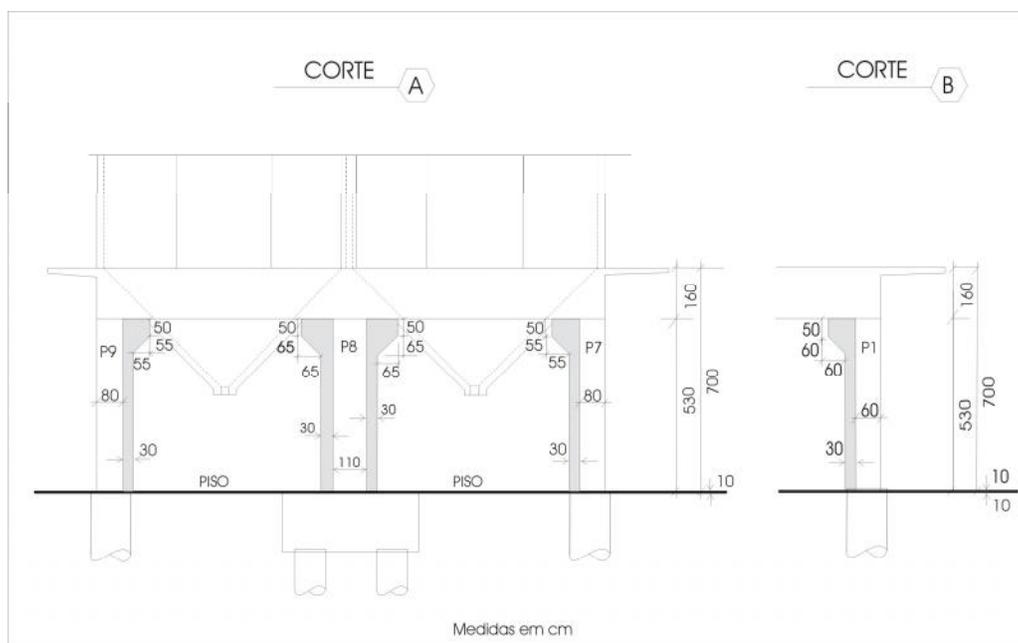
Aspecto do Projeto do Reforço dos Pilares e Laje de Transição
